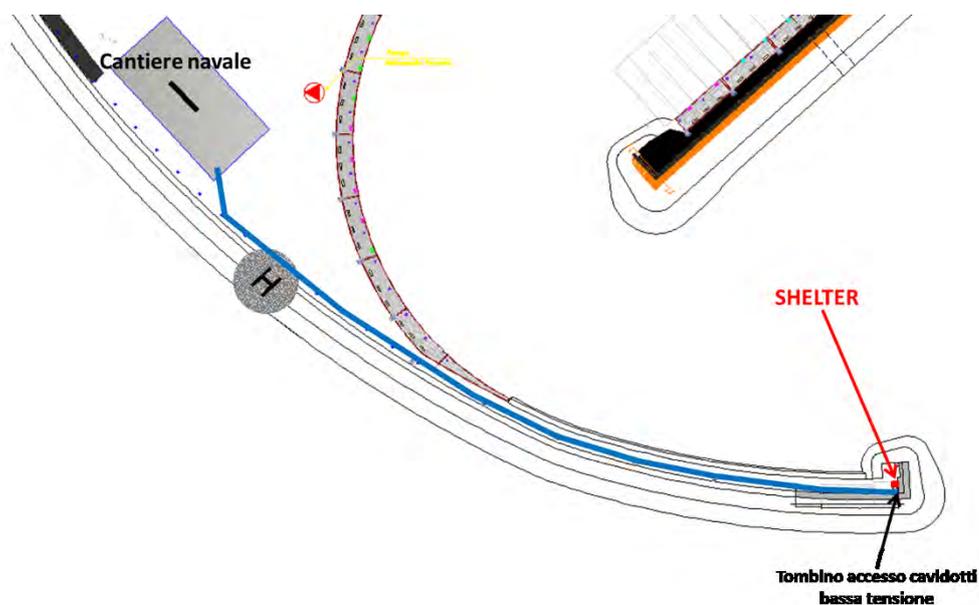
Dettaglio possibile collegamento elettrico alla linea bassa tensione del porto utilizzando prevalentemente i cavidotti della bassa tensione esistenti.
